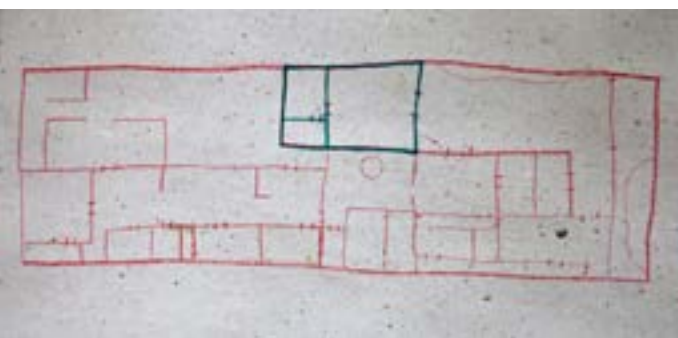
Planta baixa da casa - Fortaleza - CE
